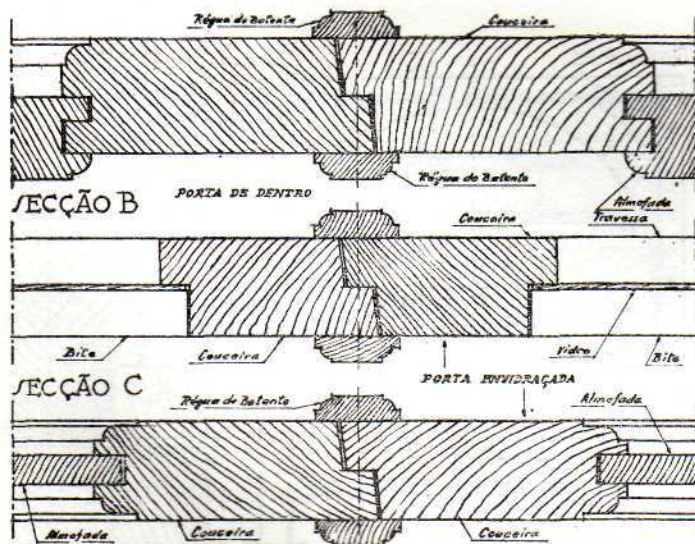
PORMENORES DA PORTA ENVIDRAÇADA (1.ª Pag.)
